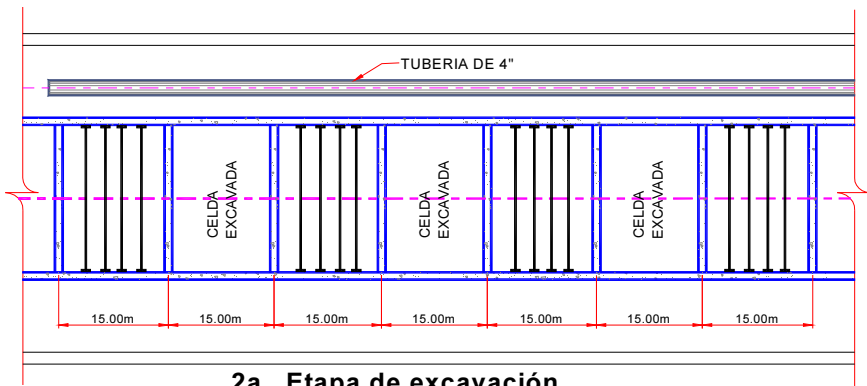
Planta de la excavación sobre el paso vial deprimido.
